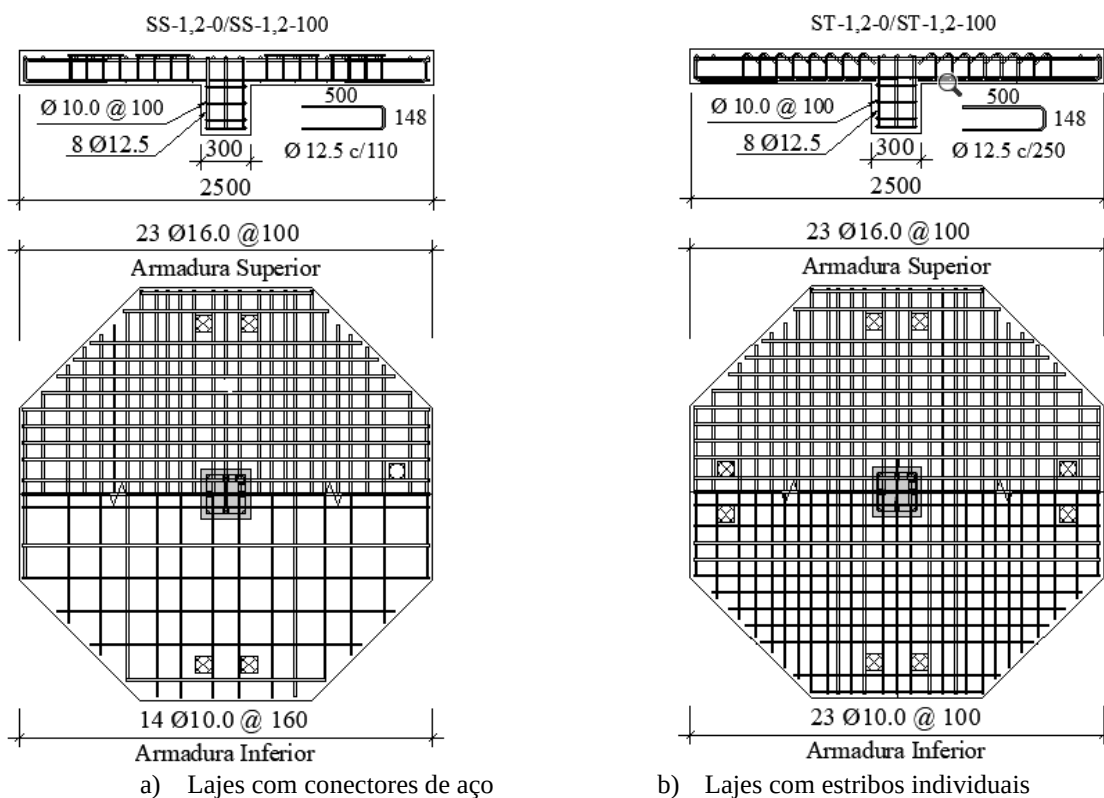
Detalhamento da armadura de flexão - 2ª Série
